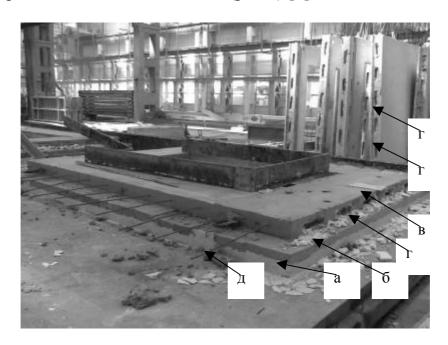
Трехслойная стеновая панель: а) наружный слой; б) средний слой-утеплитель из минеральной ваты; в) внутренний несущий слой; г) шпоночное петлевое соединение; д) арматурные выпуски из стеновых панелей.
